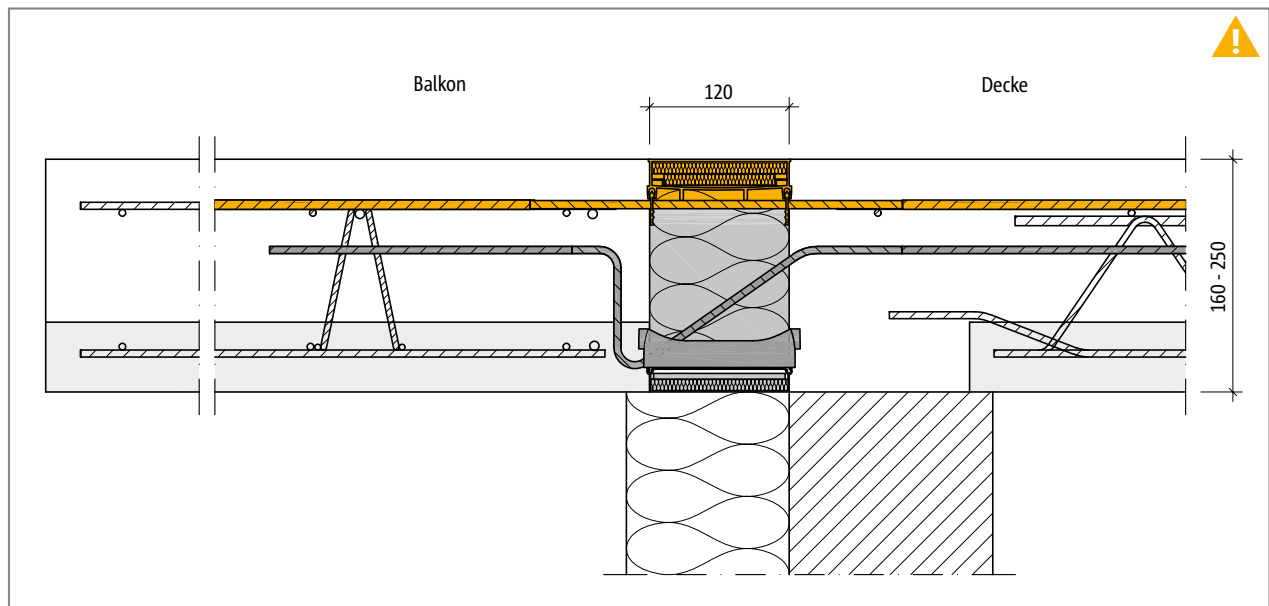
Schöck Isokorb® XT Typ K-F: Oberteil zur Zugkraftübertragung erforderlich
